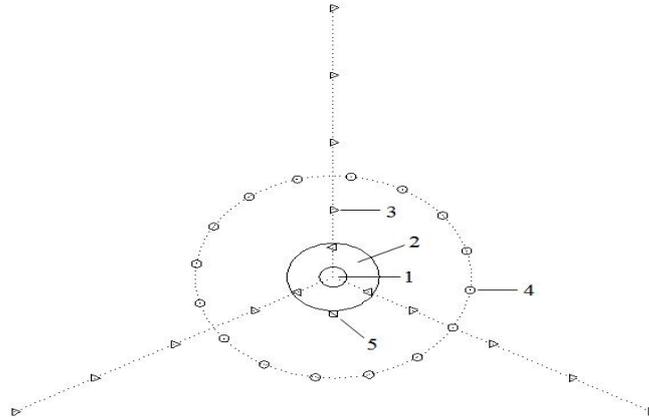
砂井浸水试验各标点布设平面示意图
